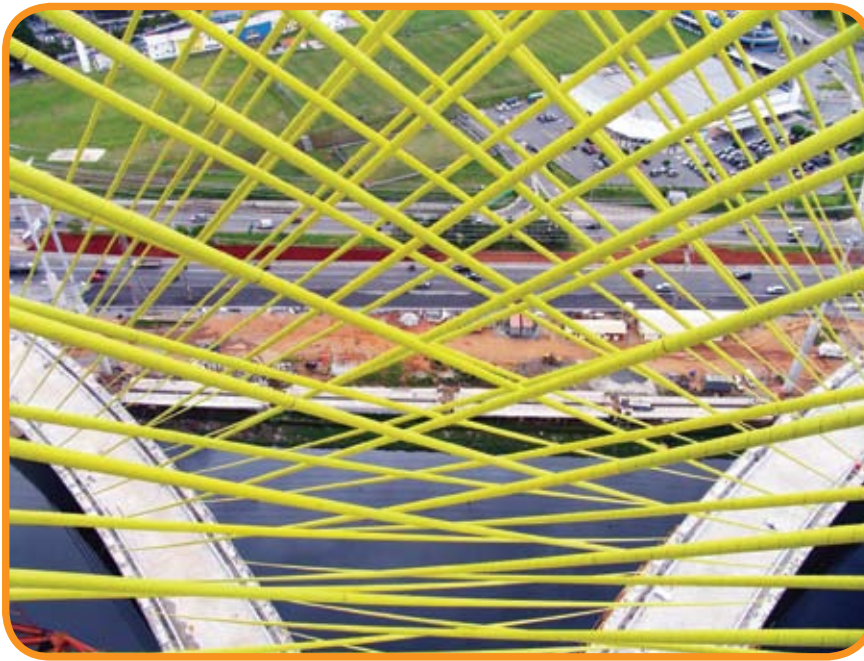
Cruzamento dos estais / Vista sobre o rio Pinheiros
